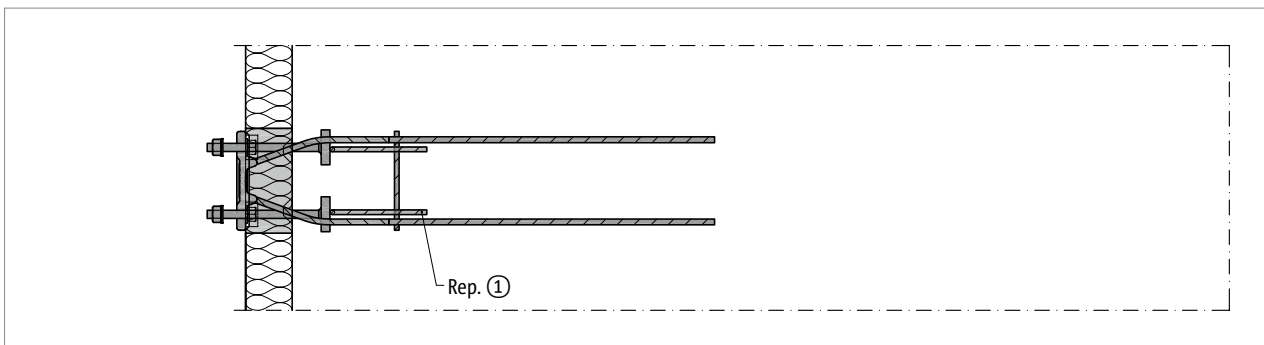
Schöck Isokorb® T type SQ : renforcement sur site, plan de base
